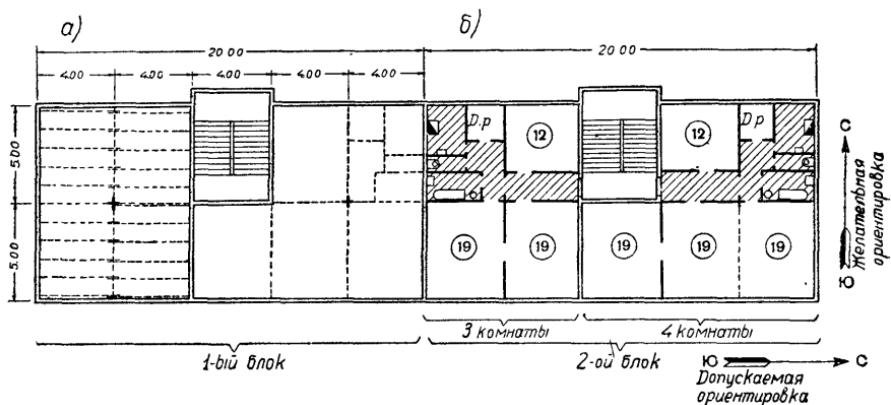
Схема планировки трех- и четырехкомнатных квартир с расположением всех вспомогательных помещений по одному фасаду; хозгруппа вдали от входа (а — схема опор и перекрытия; б — схема планировки)
